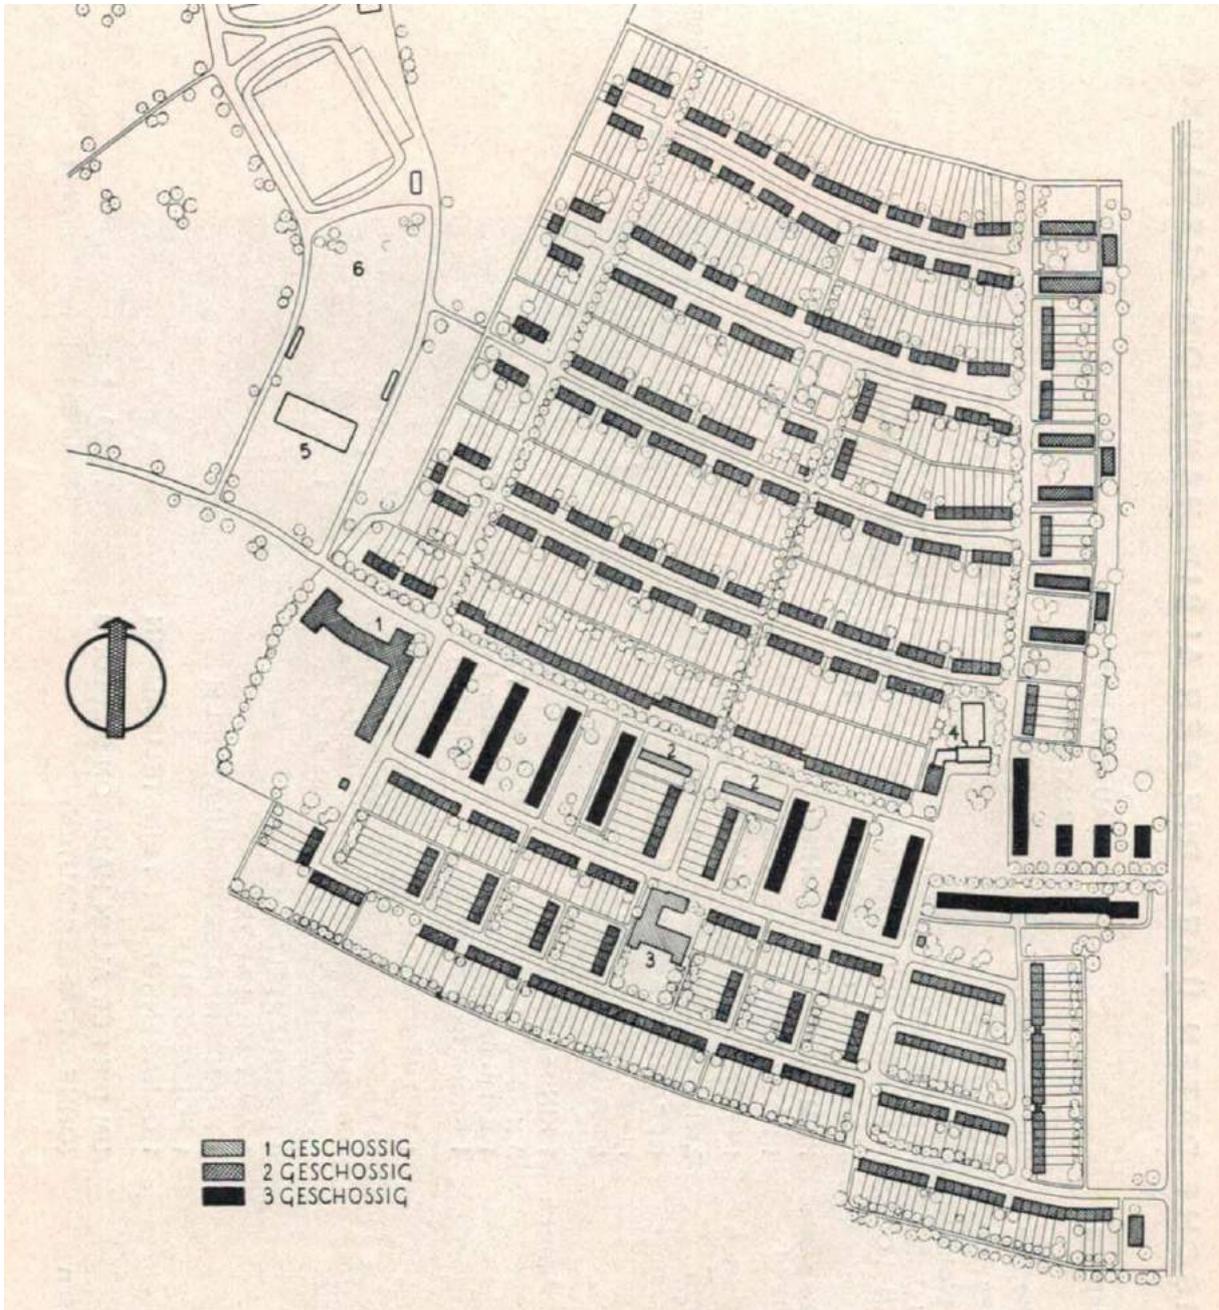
Lageplan Per-Albin-Hansson-Siedlung
